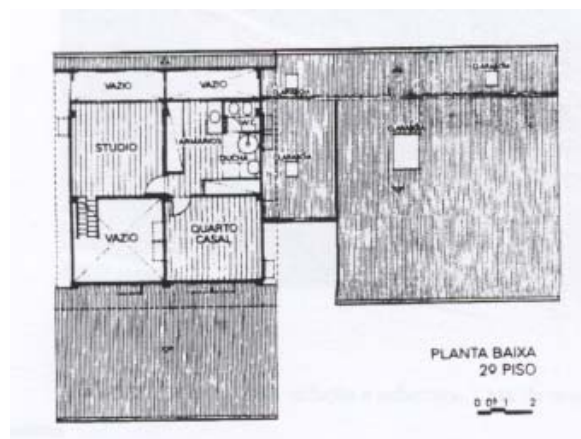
Planta do pavimento superior. Fonte: Galvão (2001)
